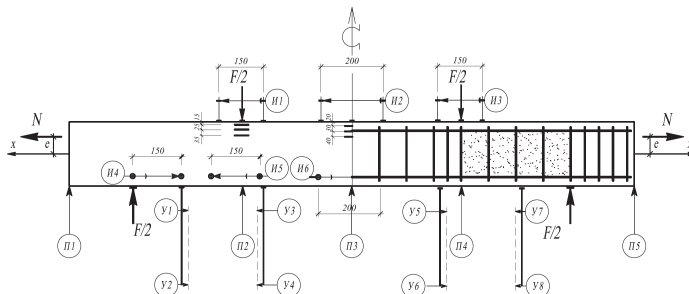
Схема навантаження, розташування приладів та наклейки тензорезисторів у дослідних балках.
